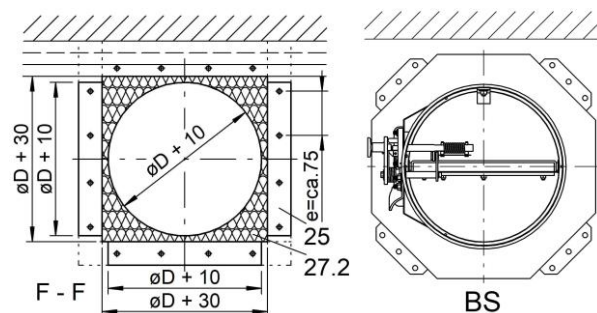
montaggio a secco con telaio AR su parete divisoria leggera sotto soffitto massiccio
